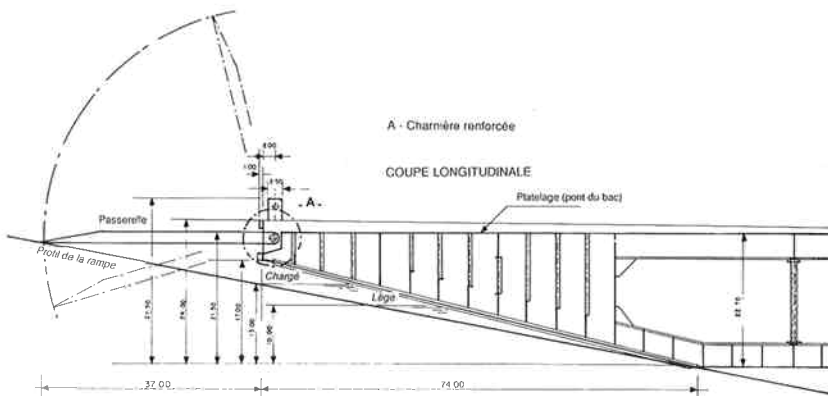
Schéma de passerelle de bac longitudinal
